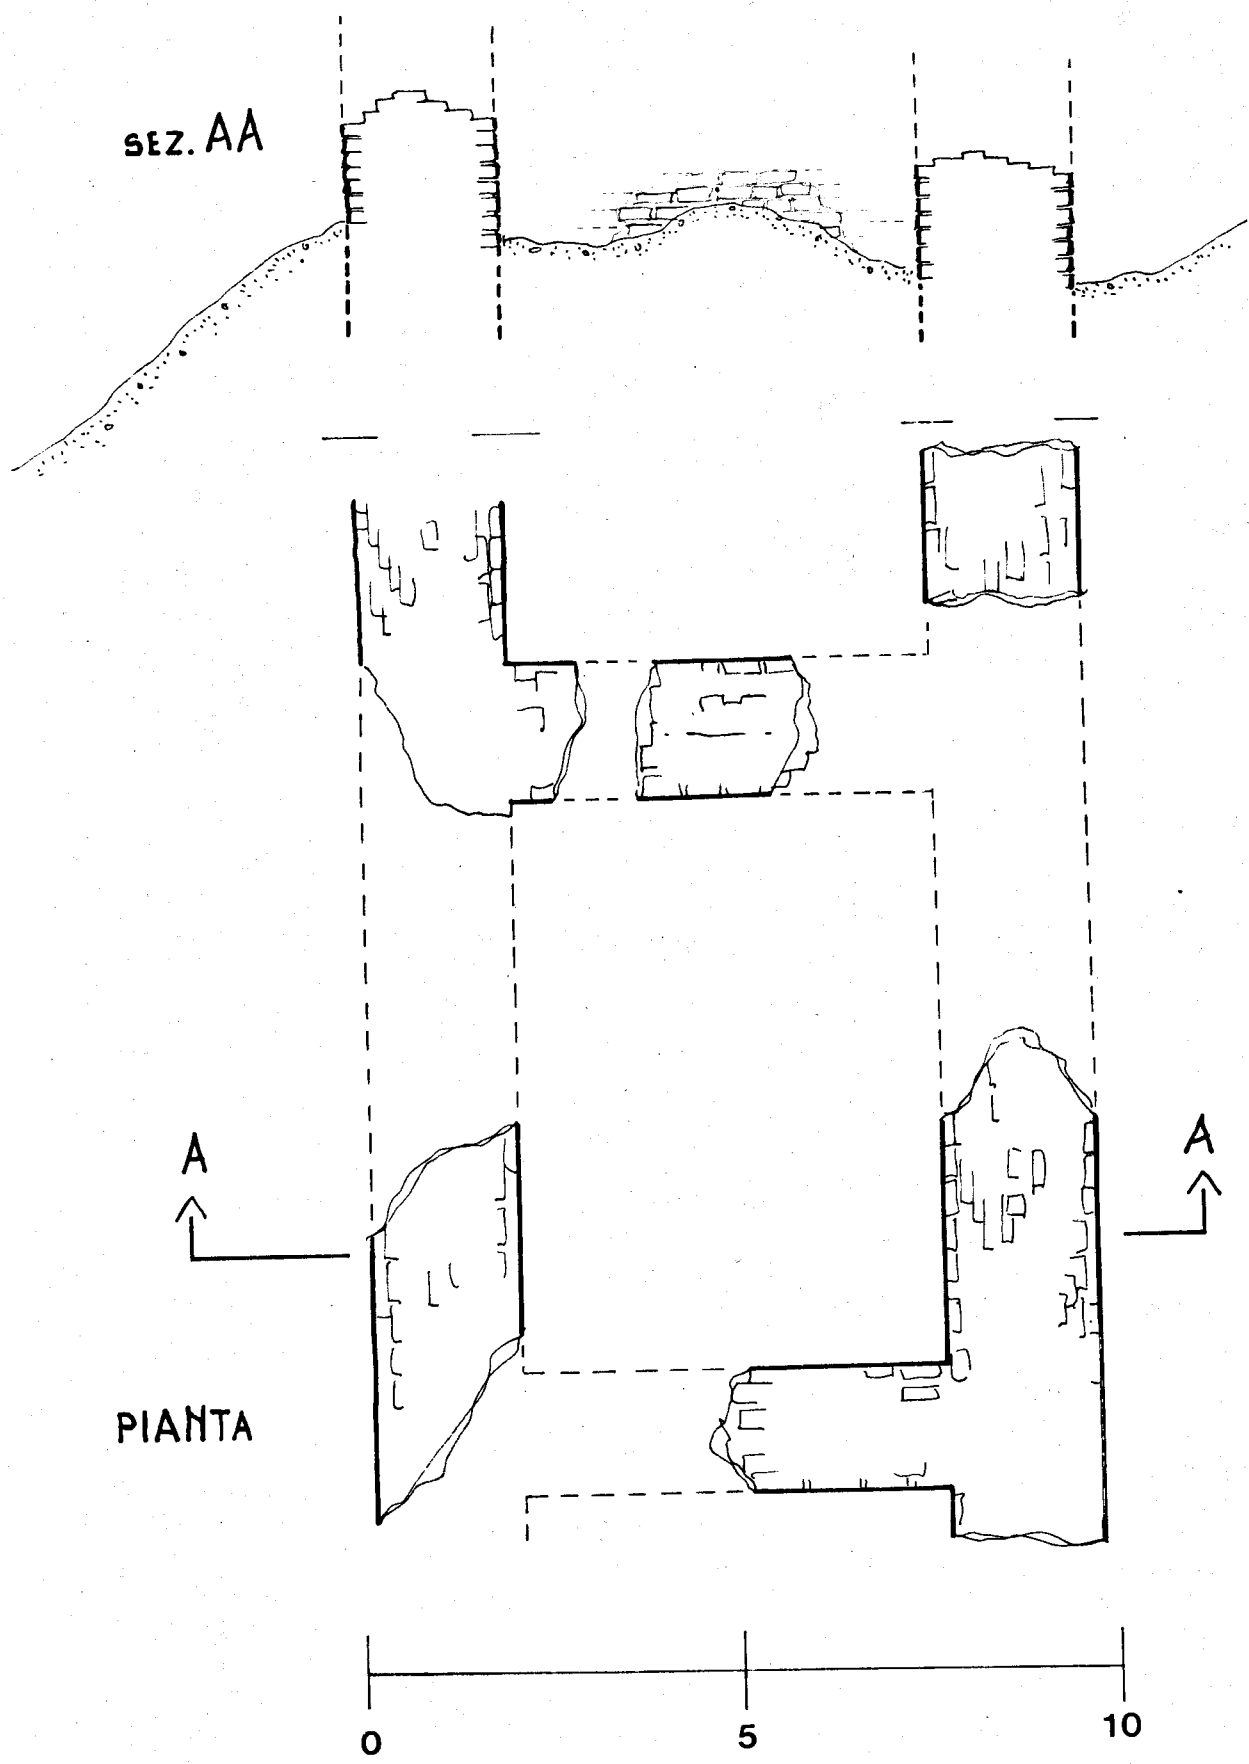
Pianta e sezione di un tratto della cinta muraria.
